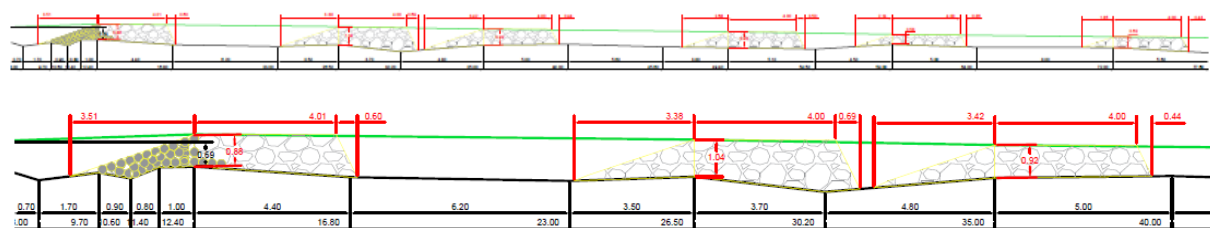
Plan complet de maîtrise d'œuvre pour le Chabosson et zoom sur la première partie du plan — en mètre (Auteur : Illona Doyon)
